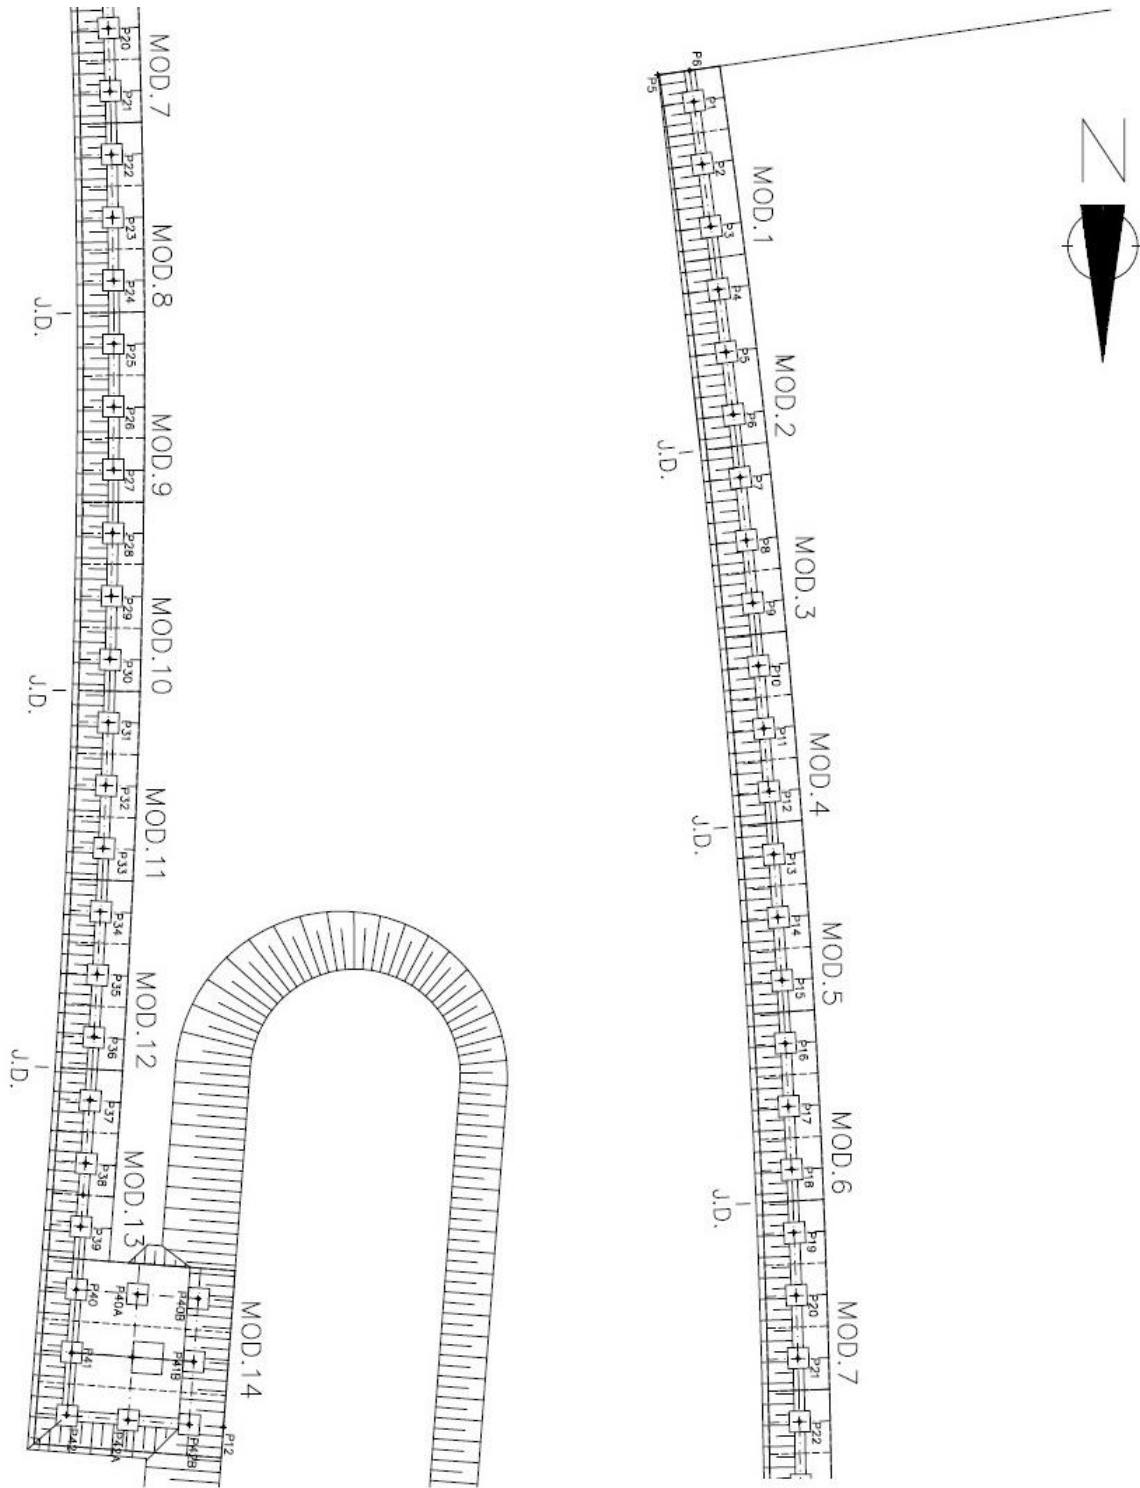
Planta esquemática do Passadiço da Doca dos Olivais.
